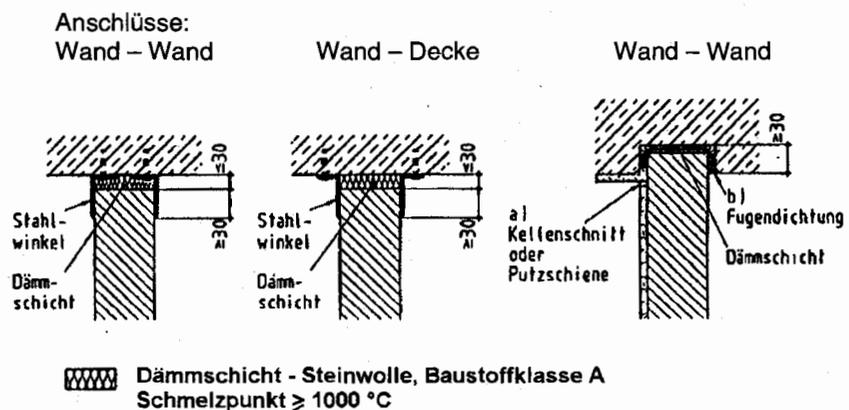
Statisch erforderliche Anschlüsse von Brandwänden aus Mauerwerk oder Stahlbeton an angrenzende Stahlbetonbauteile (Beispiele)
